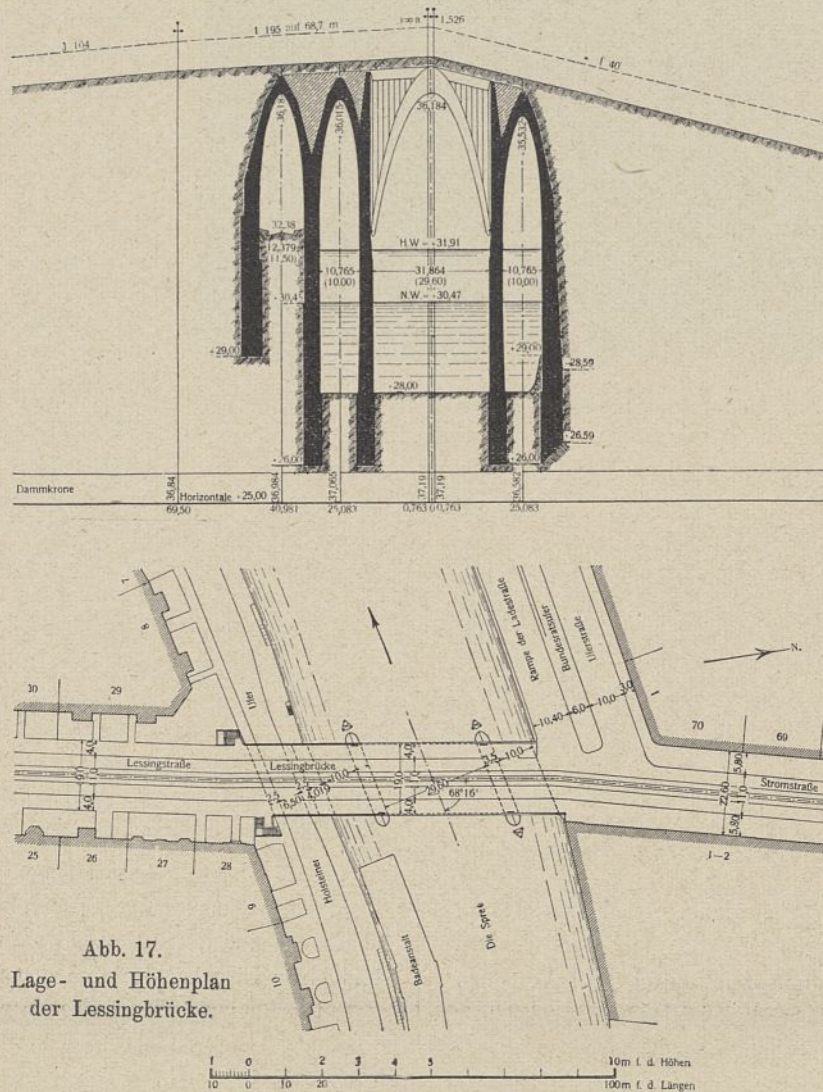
Lage- und Höhenplan der Lessingbrücke.
